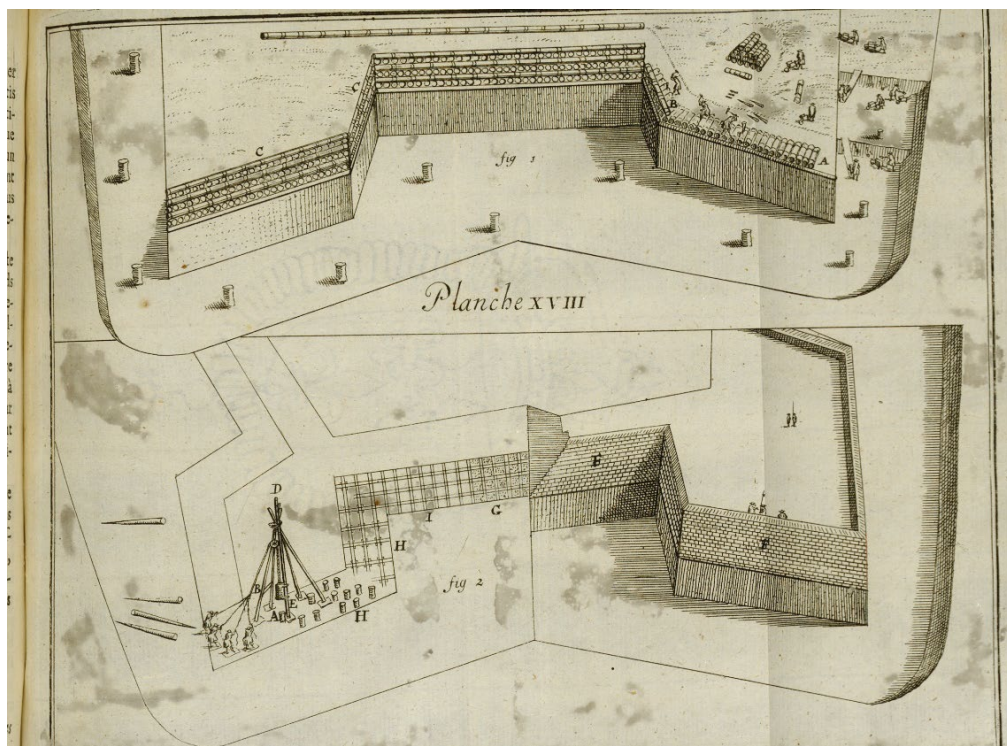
Planche XVIII* (De Medrano, 1696).
